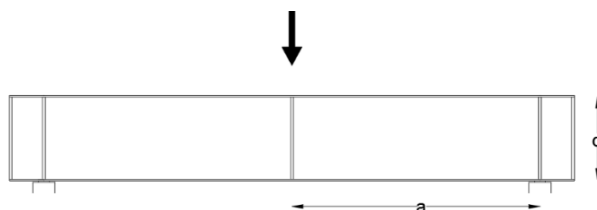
Configuração corrente das vigas do Ensaio 1
